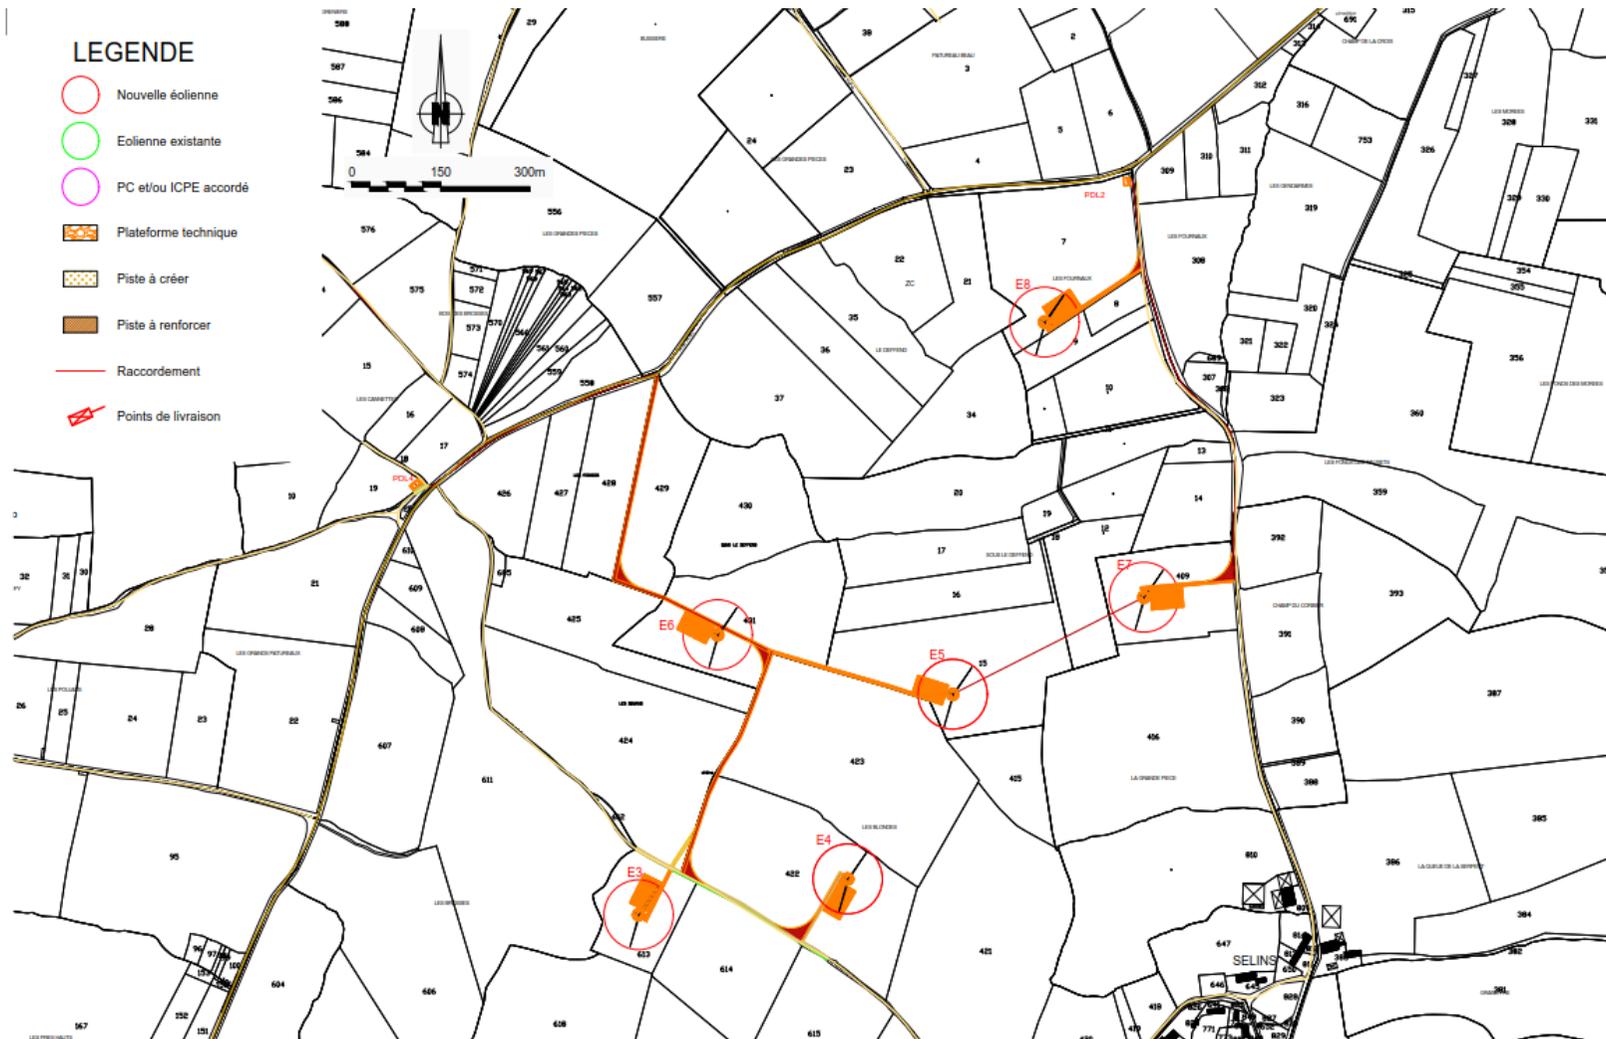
PLAN D'IMPLANTATION DES EOLIENNES AVEC CHEMIN D'ACCES ET POSTES DE LIVRAISON – FOND CADASTRAL
